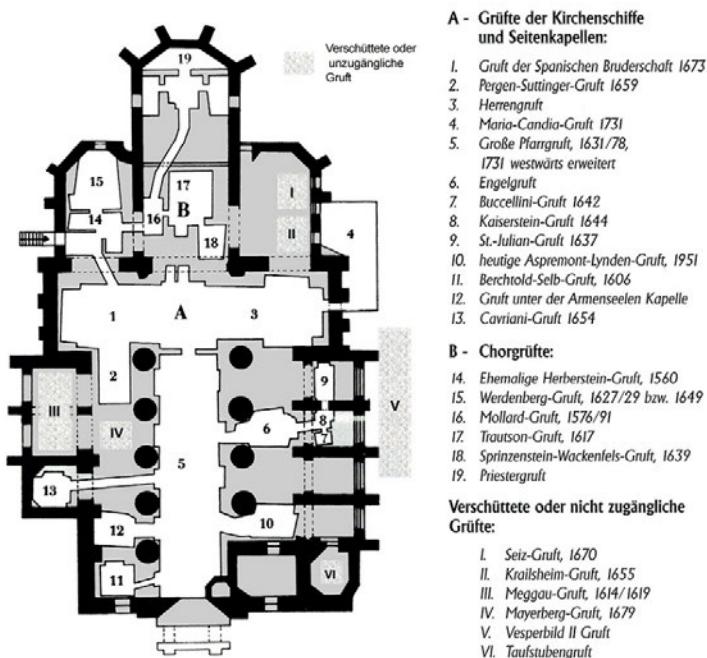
Wien, Michaelergruft. Grundriss.
